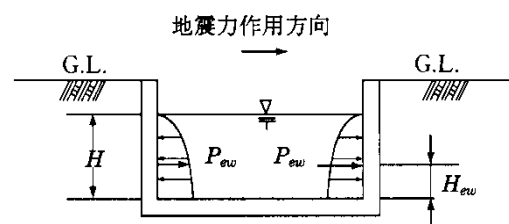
矩形構造物 (自由水面有り) に作用する動水圧 (Westergaard法)
